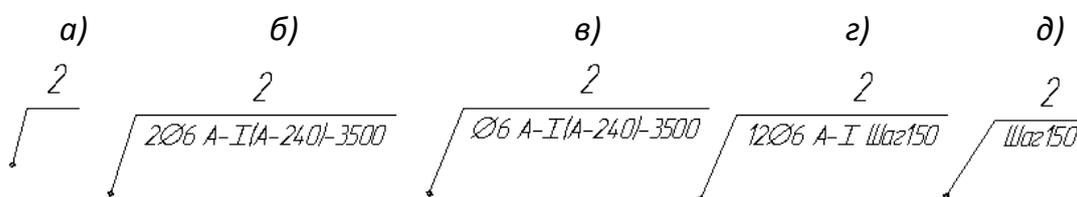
Маркировка арматуры на чертежах железобетонных конструкций
